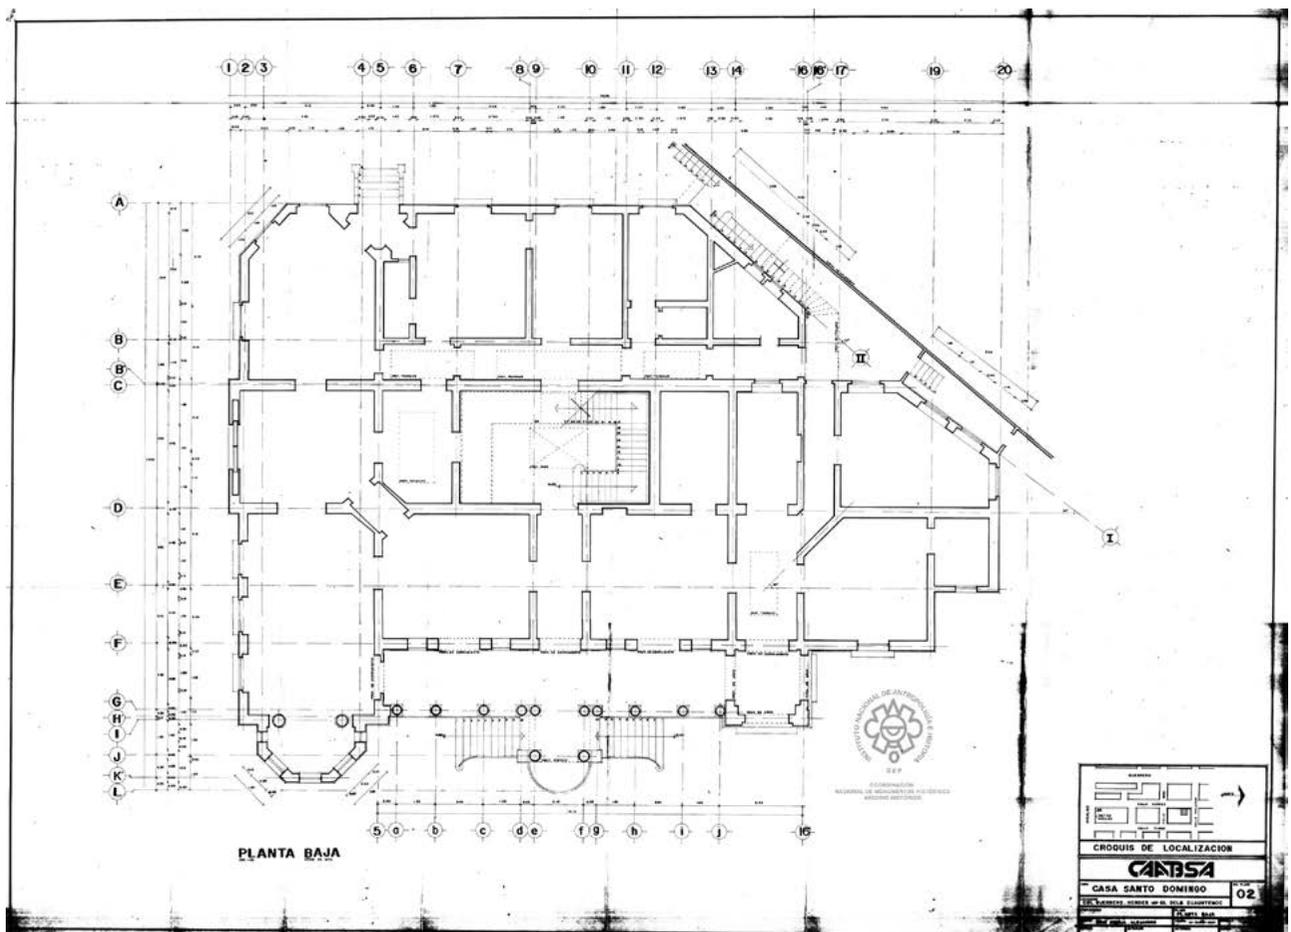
Plano de la casa de Antonio Rivas Mercado, planta baja. Fuente: Archivo Histórico Jorge Enciso (AHIE)-CNMH-INAH.
